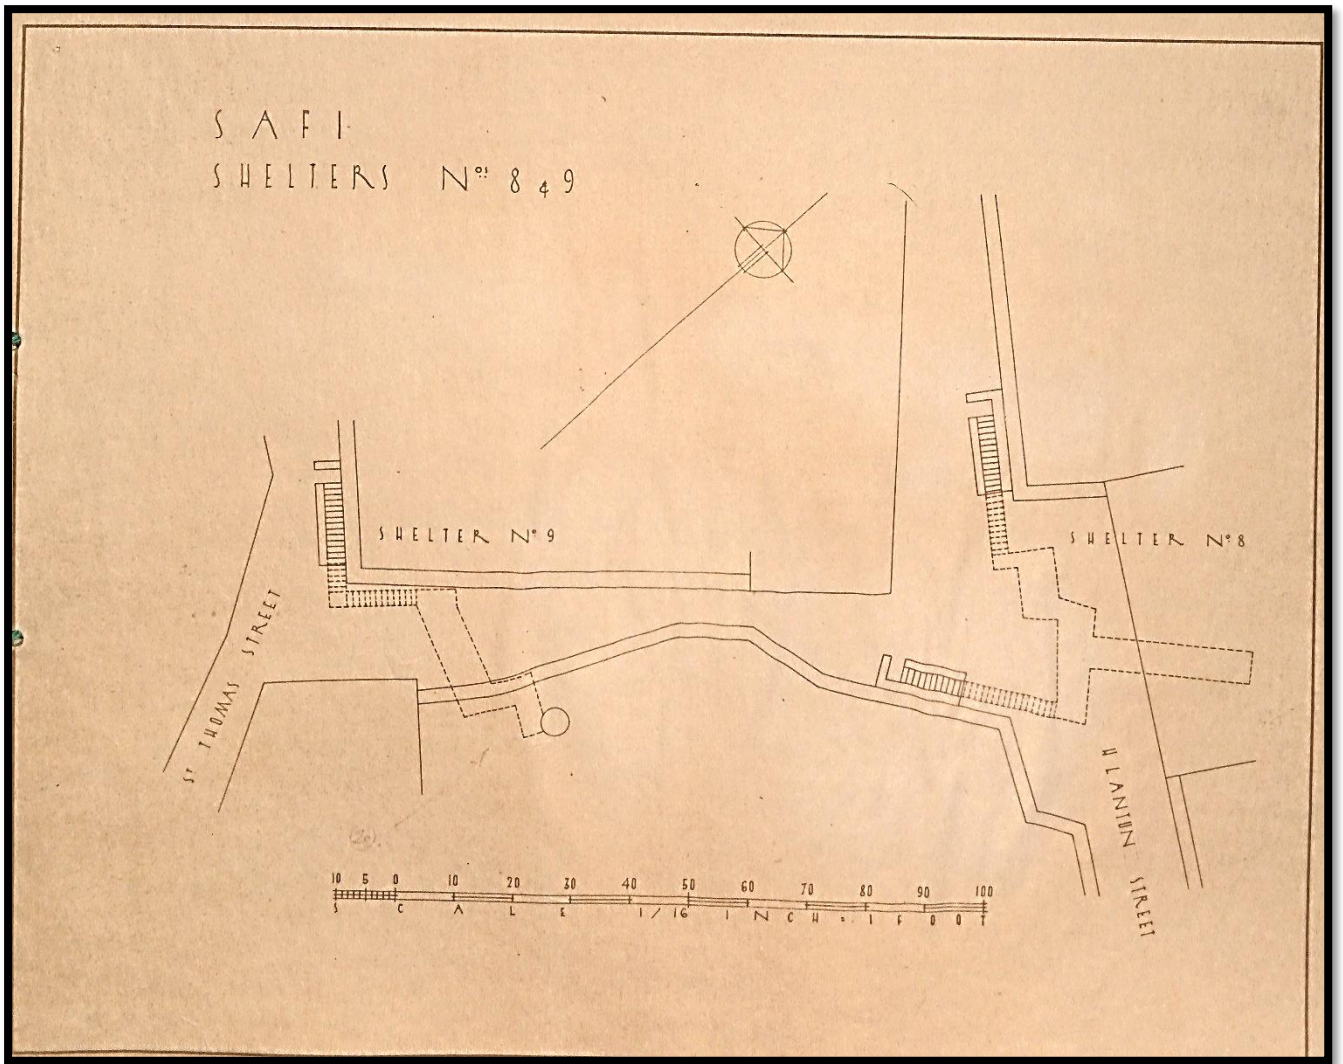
Planta do Abrigo nº8 e 9 "St. Thomas Street – Hlanium Street."
